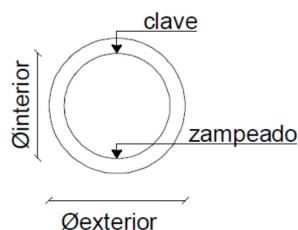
Cotas de clave, zampeado, diámetro interior y exterior de una tubería.
